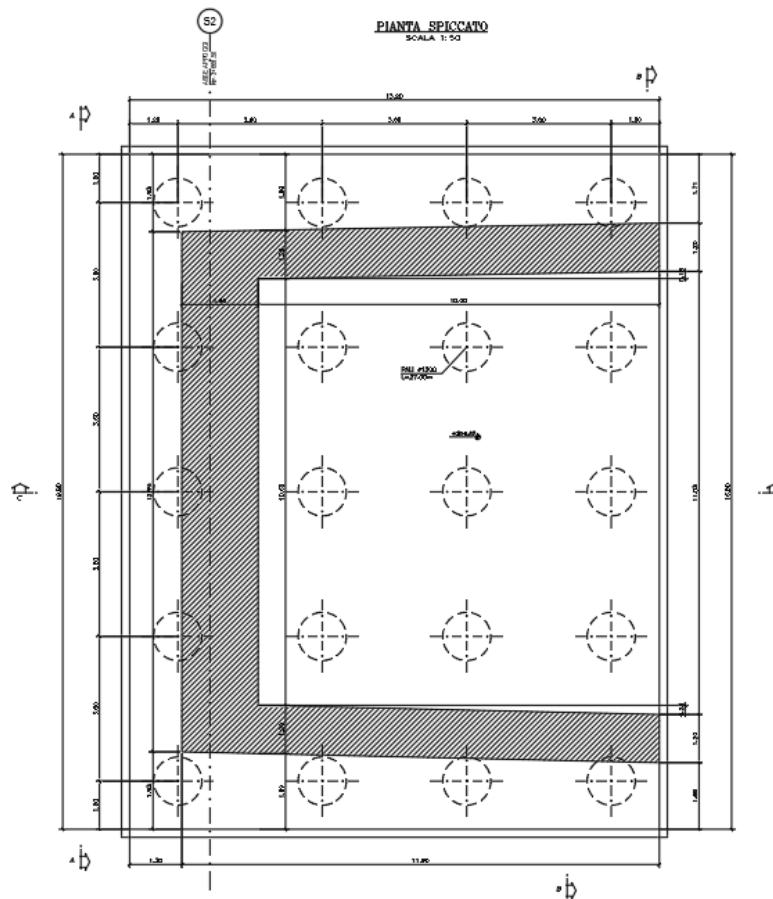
Pianta Fondazioni – Spalla 2
